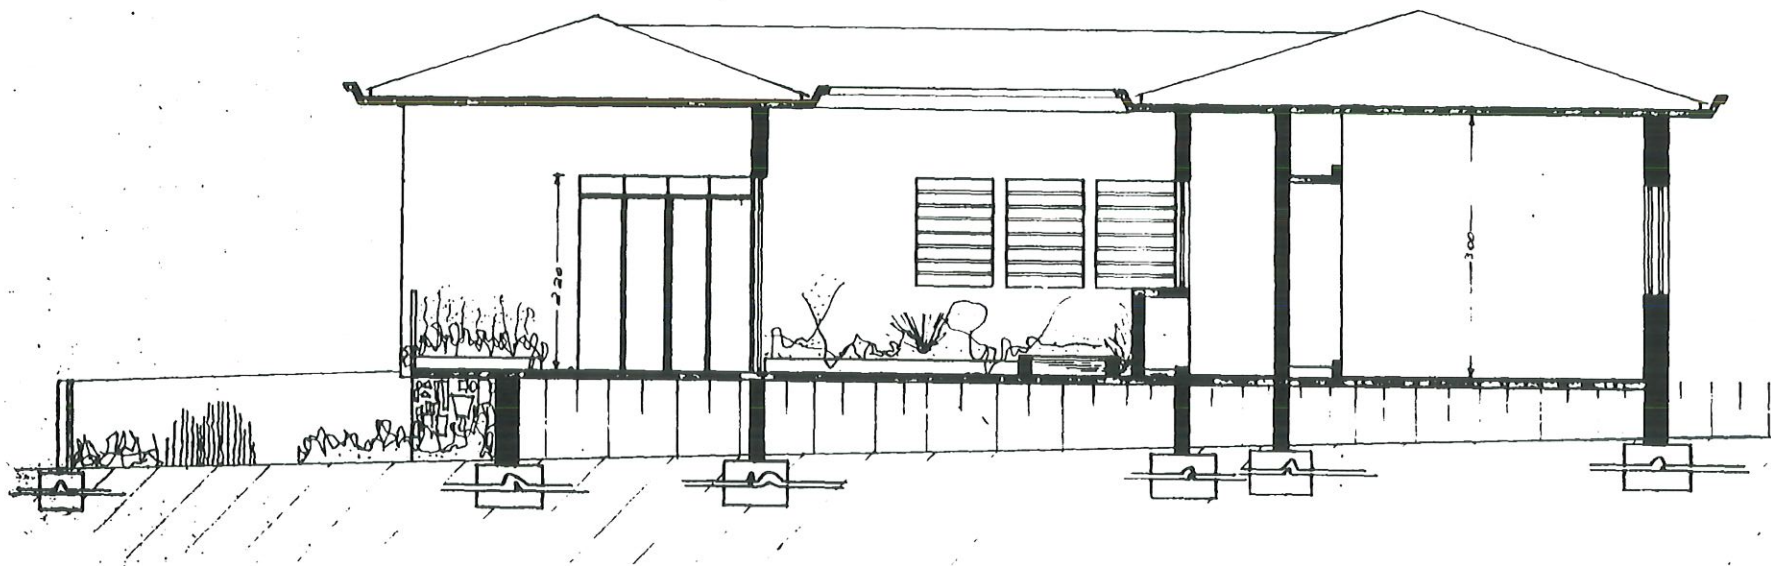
Residência Gilberto Cunha Machado – 1960 - Planta
